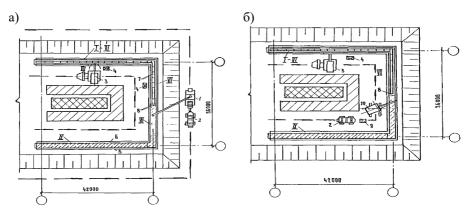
Схемы производства опалубочных и бетонных работ при возведении монолитной стены
